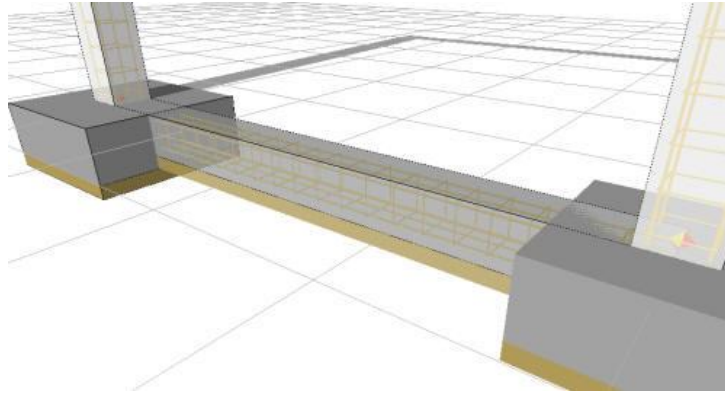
Viga de atado de hormigón armado. Fuente: Google imágenes.
